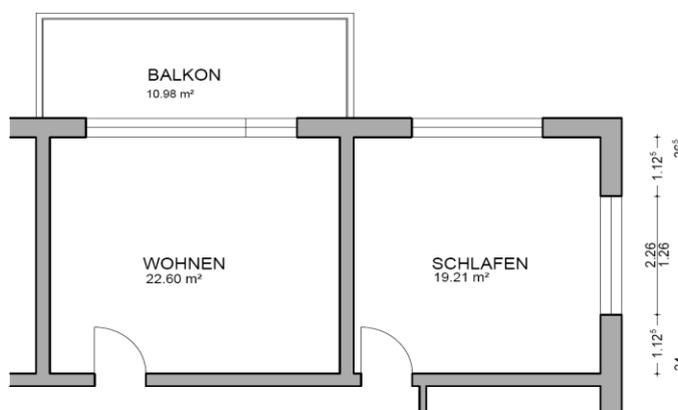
Grundrissausschnitt der für die Berechnungen zugrunde gelegten Wohnung.
